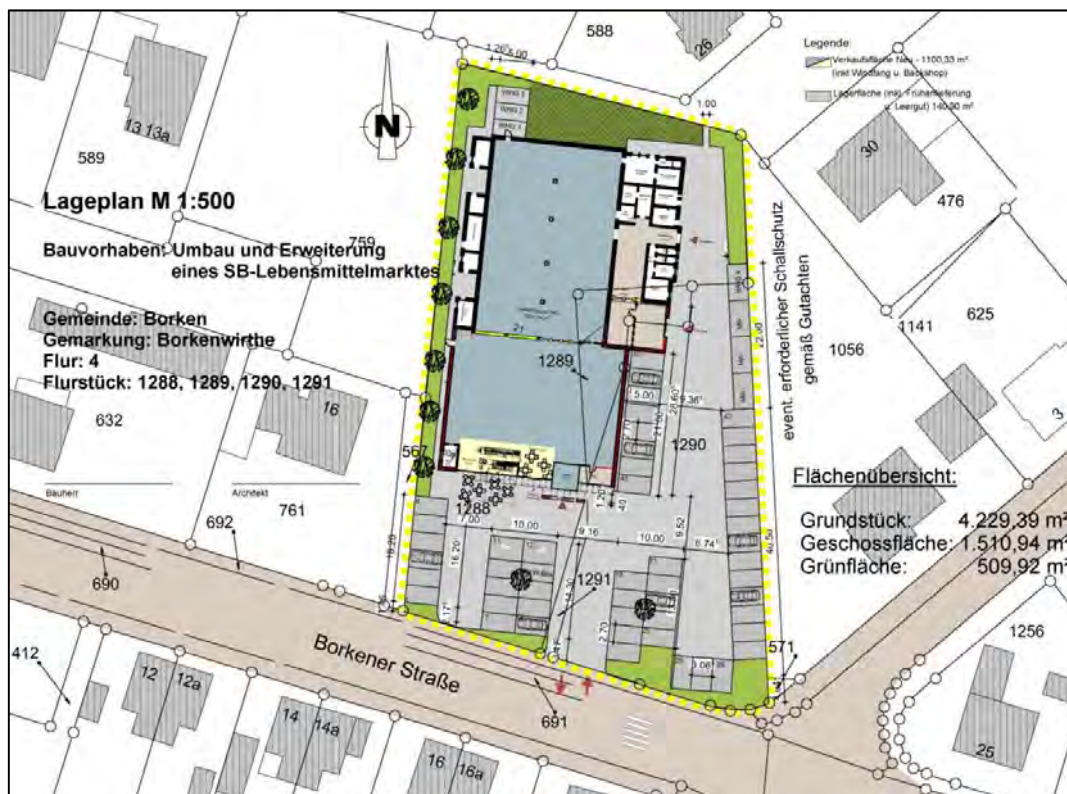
Lageplan zum Bauvorhaben (Stand 26.08.2014) /16/
